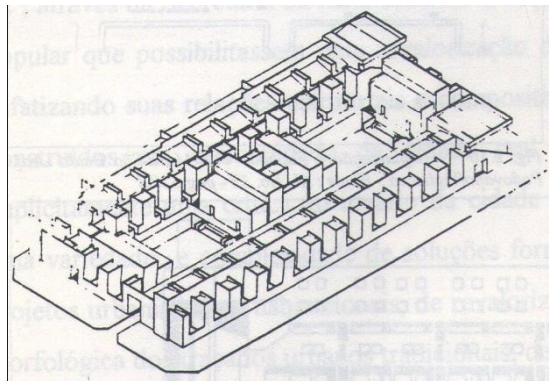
Conjunto Vila Mara – Vista da Articulação – Praça de acessos horizontais-verticais de pedestres – São Paulo – Arq. Padovano e Vigliecca
